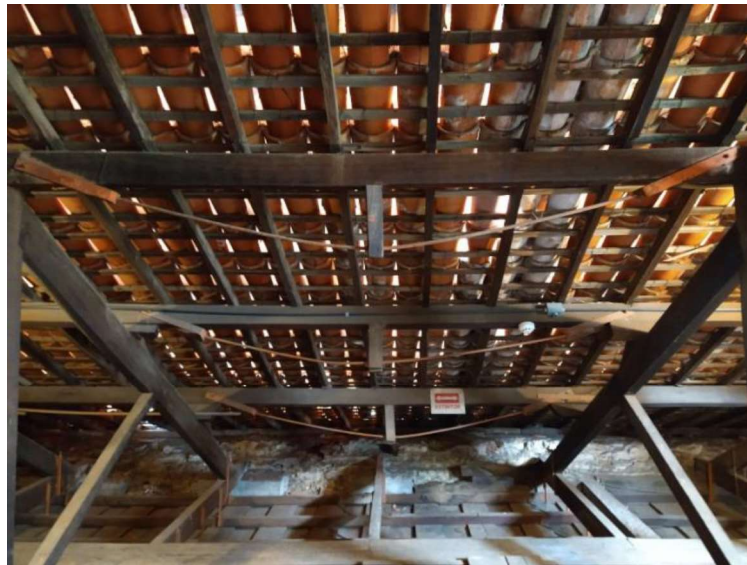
Hastes metálicas utilizadas para impedir a deformação dos componentes de madeira do telhado.
